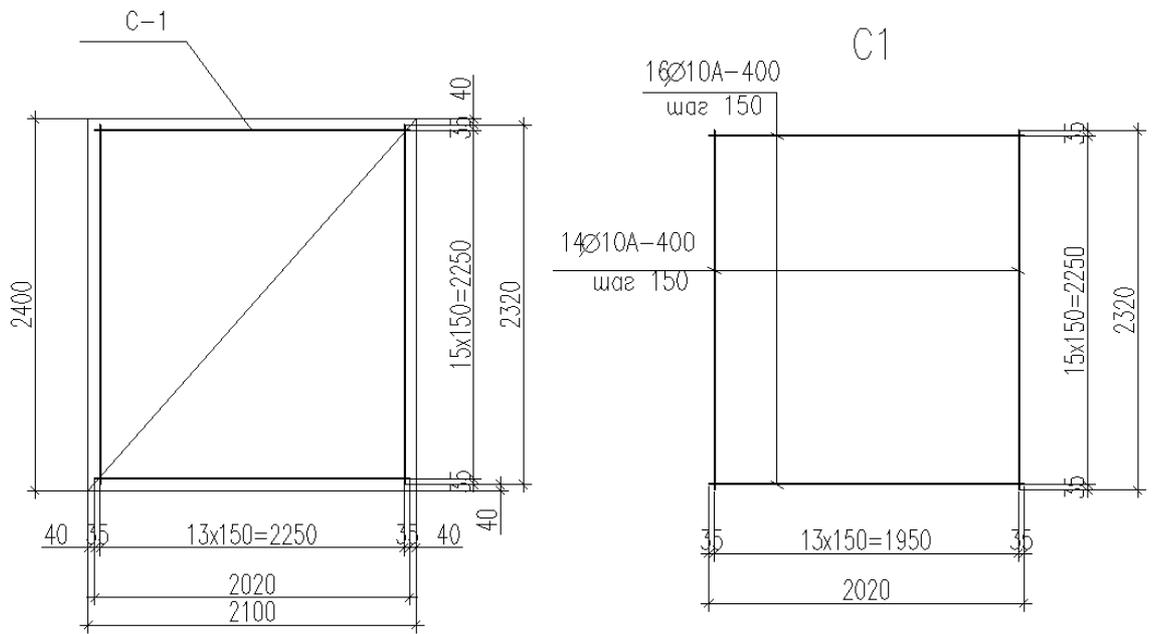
Схема армирования подошвы фундамента ФМ3-2
